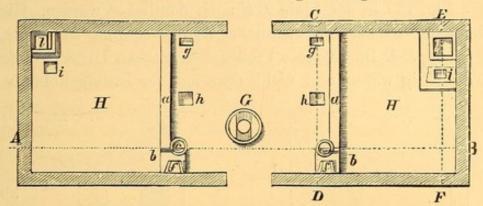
Grundriß des Kelterhauses von Stabiae.
